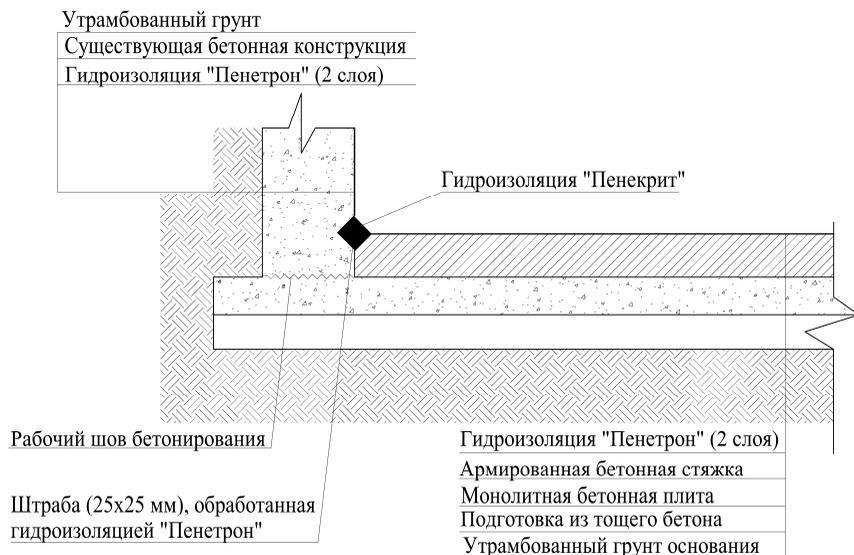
Б. Устройство гидроизоляции по армированной бетонной стяжке
